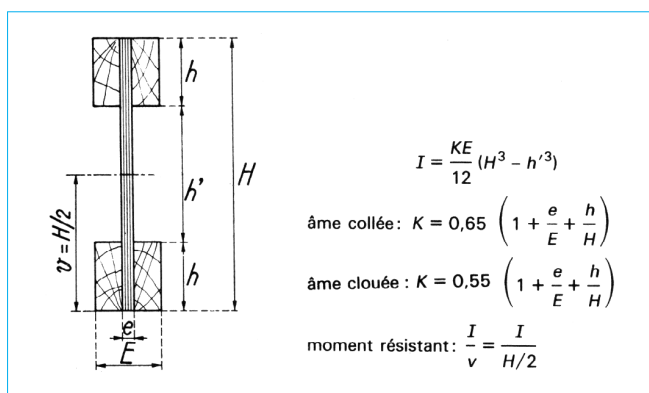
Calcul d'inertie transversale des poutres en I ou fermes composées à âme en contreplaqué
